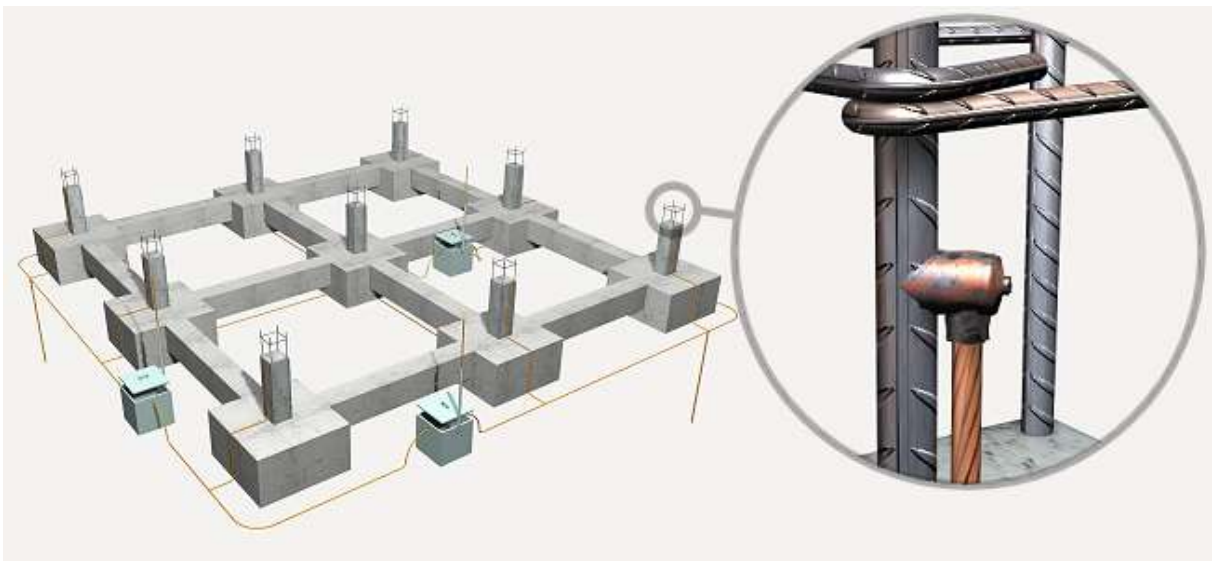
Aterramento em malha conectada à fundação. Fonte: generadordeprecios
